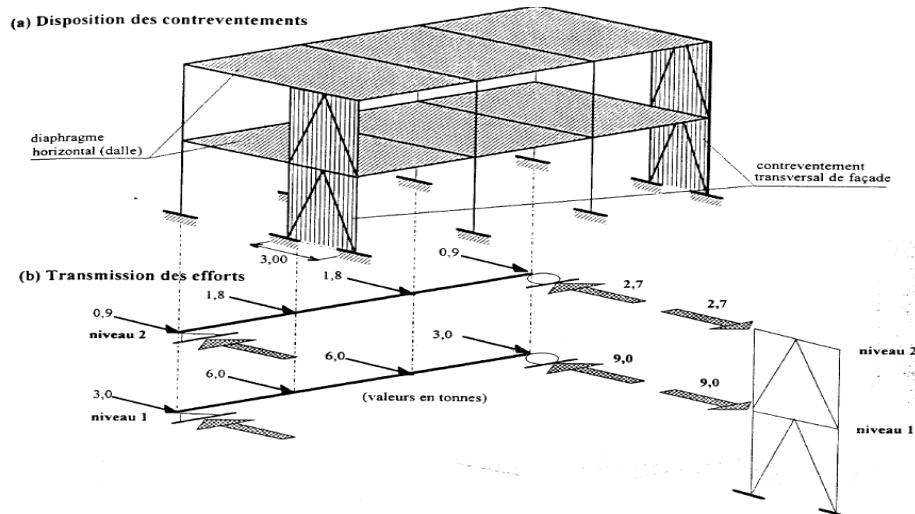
vent transversal : deux contreventement verticaux en façades pignons et utilisation du plancher diaphragme comme contreventement horizontal
